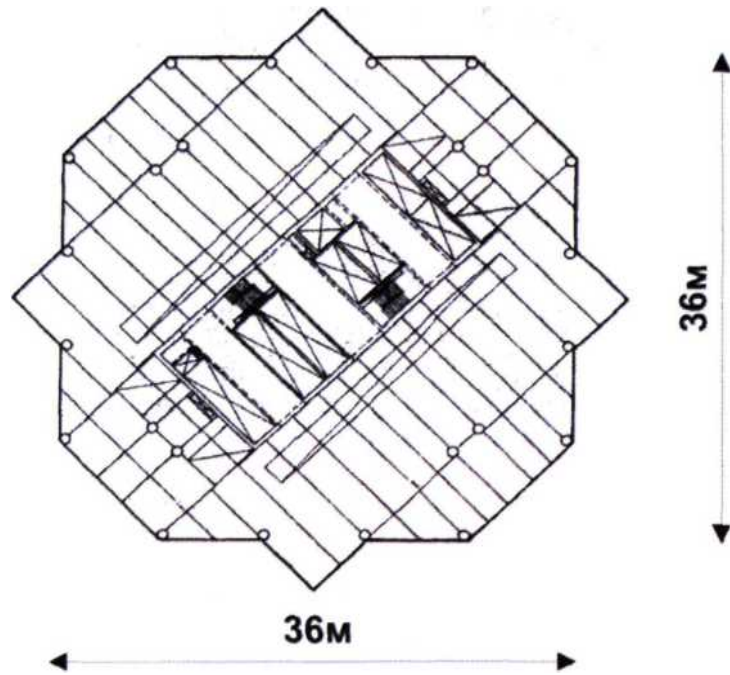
План житлового будинку з трубобетонних колонами в м Мельбурн, Австралія
